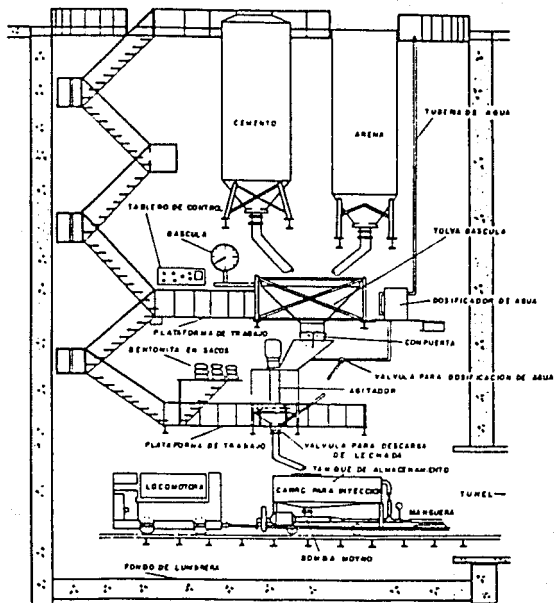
PLANTA DOSIFICADORA PARA INYECCION
